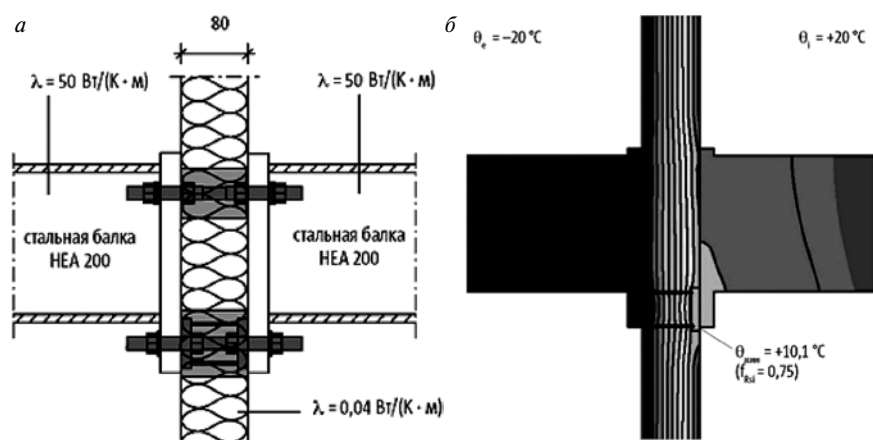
Соединение стальной балки HEA 200 с использованием Schöck Isokorb® тип KST16: а – конструктивное решение узла; б – температурное поле узла
